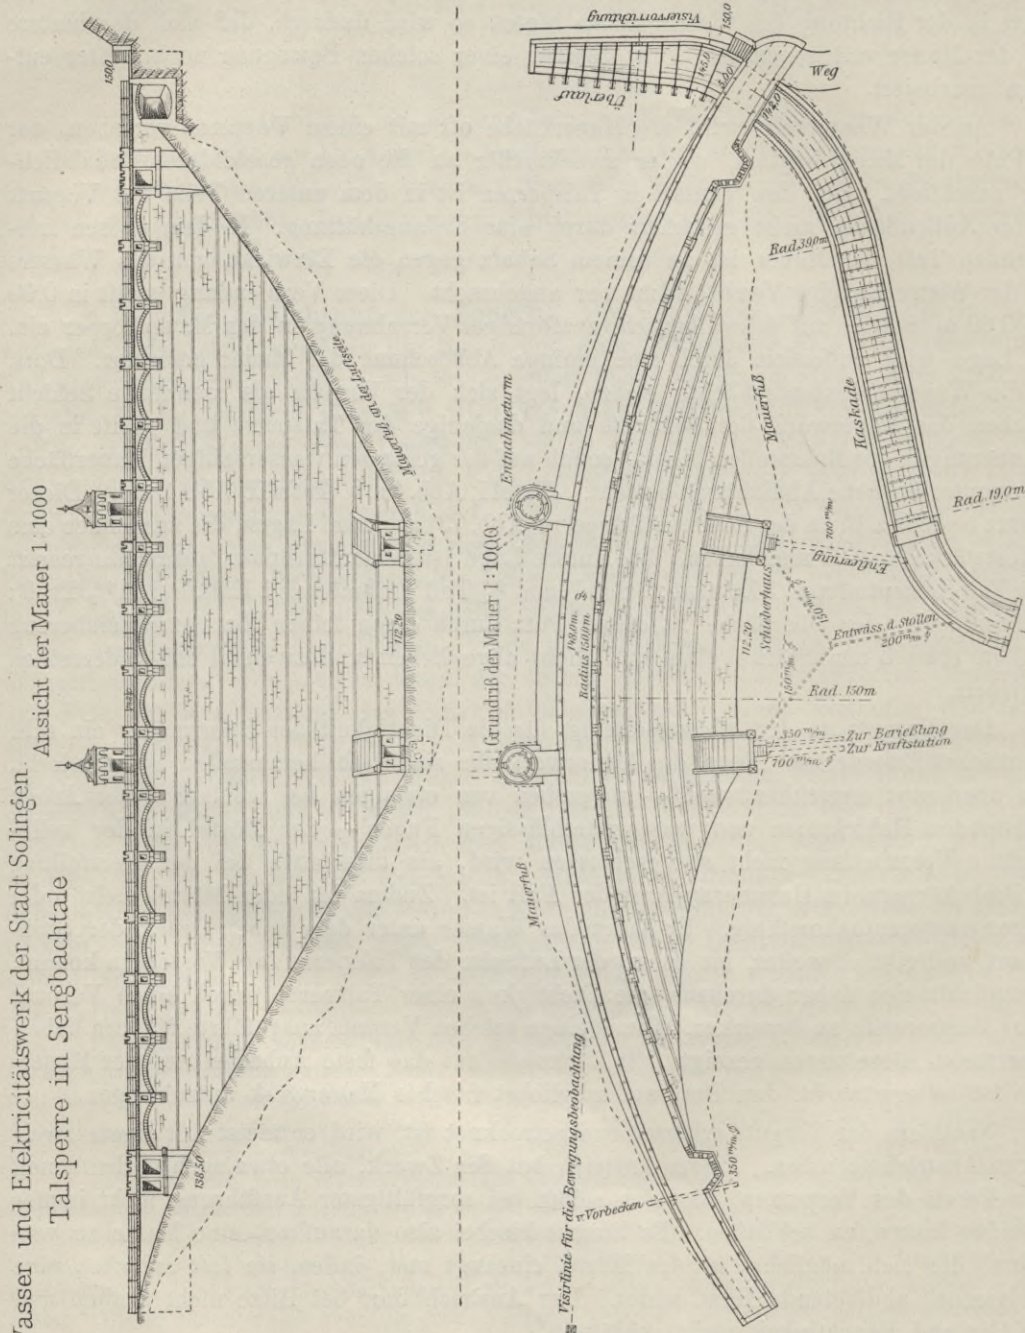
Grundriß und Aufriss der Solinger Talsperre.
